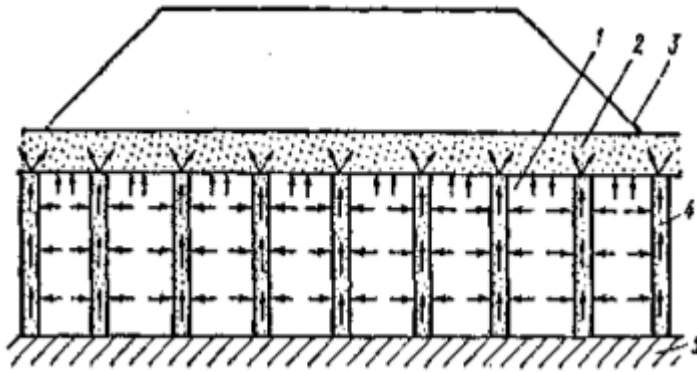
Схема уцілення слабого ґрунту статичним навантаженням: 1 - слабкий ґрунт; 2 - пластовий дренаж; 3 - навантаження у вигляді насипу; 4 - вертикальні дрени (стрілками вказано напрямок віджимання води з ґрунту); 5 - щільний ґрунт
